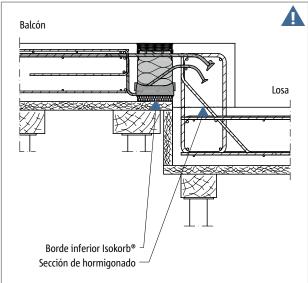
Schöck Isokorb® XT tipo K-U: Balcón de hormigón in situ con desplazamiento de altura hacia abajo
